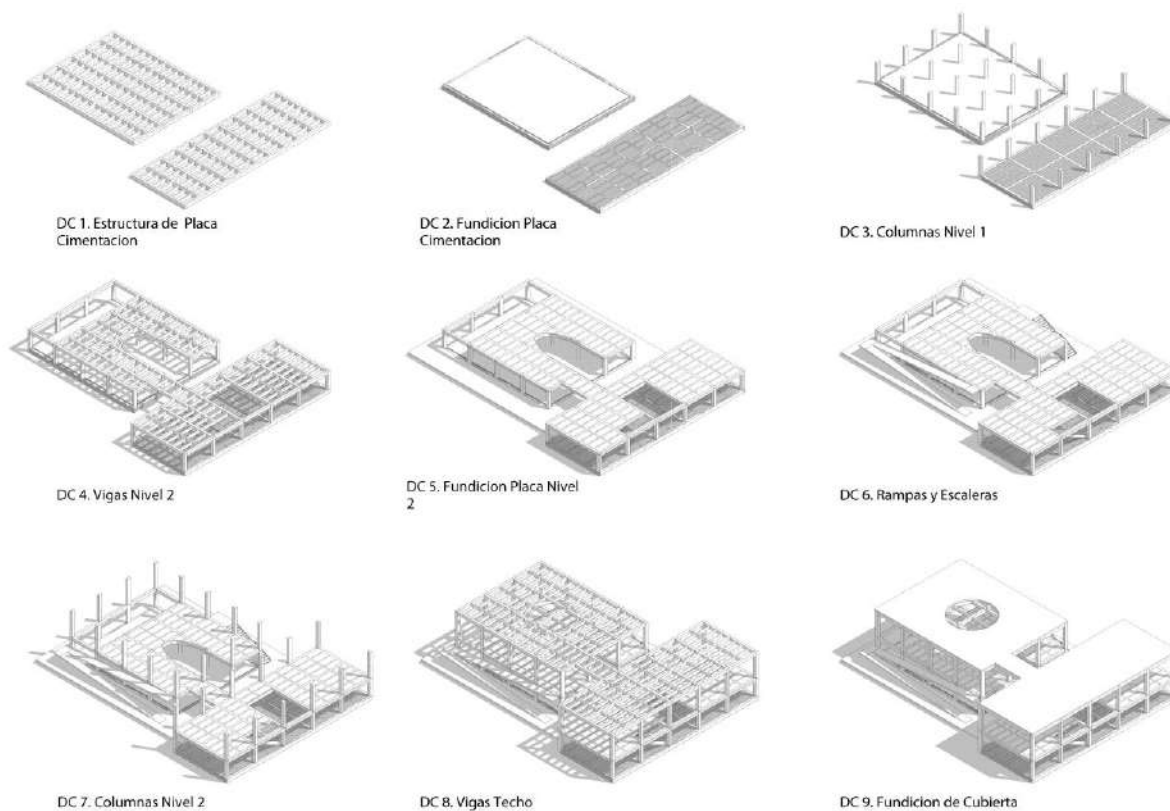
Desarrollo Constructivo del proyecto. Fuente: Elaboración propia
